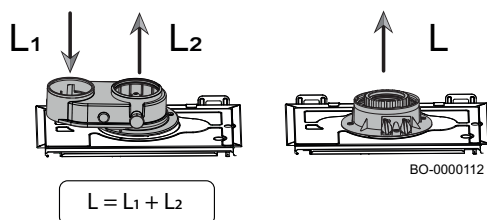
Afzonderlijke voorbeelden leidingsinstallatie
